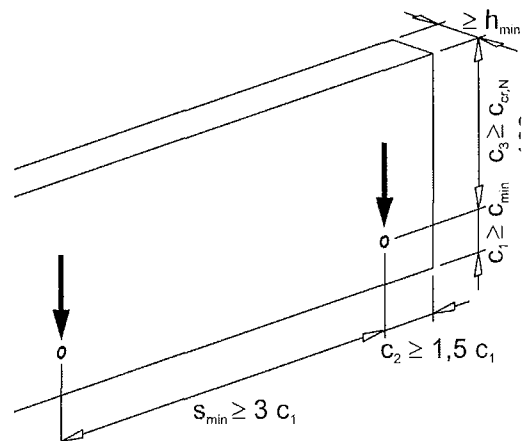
Einbausituation Wandfläche - Querbeanspruchung, ohne Rückhängebewehrung
